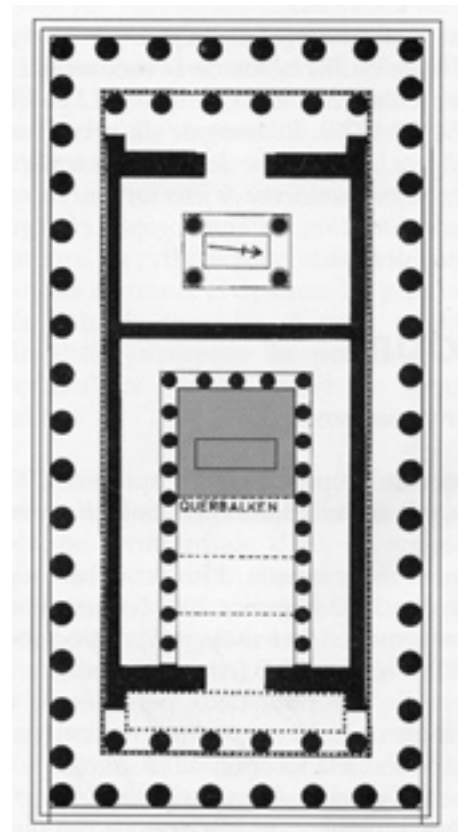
Plan avec les poutres de traverse et l'espace lumineux. Bérard 2002, p. 7.
